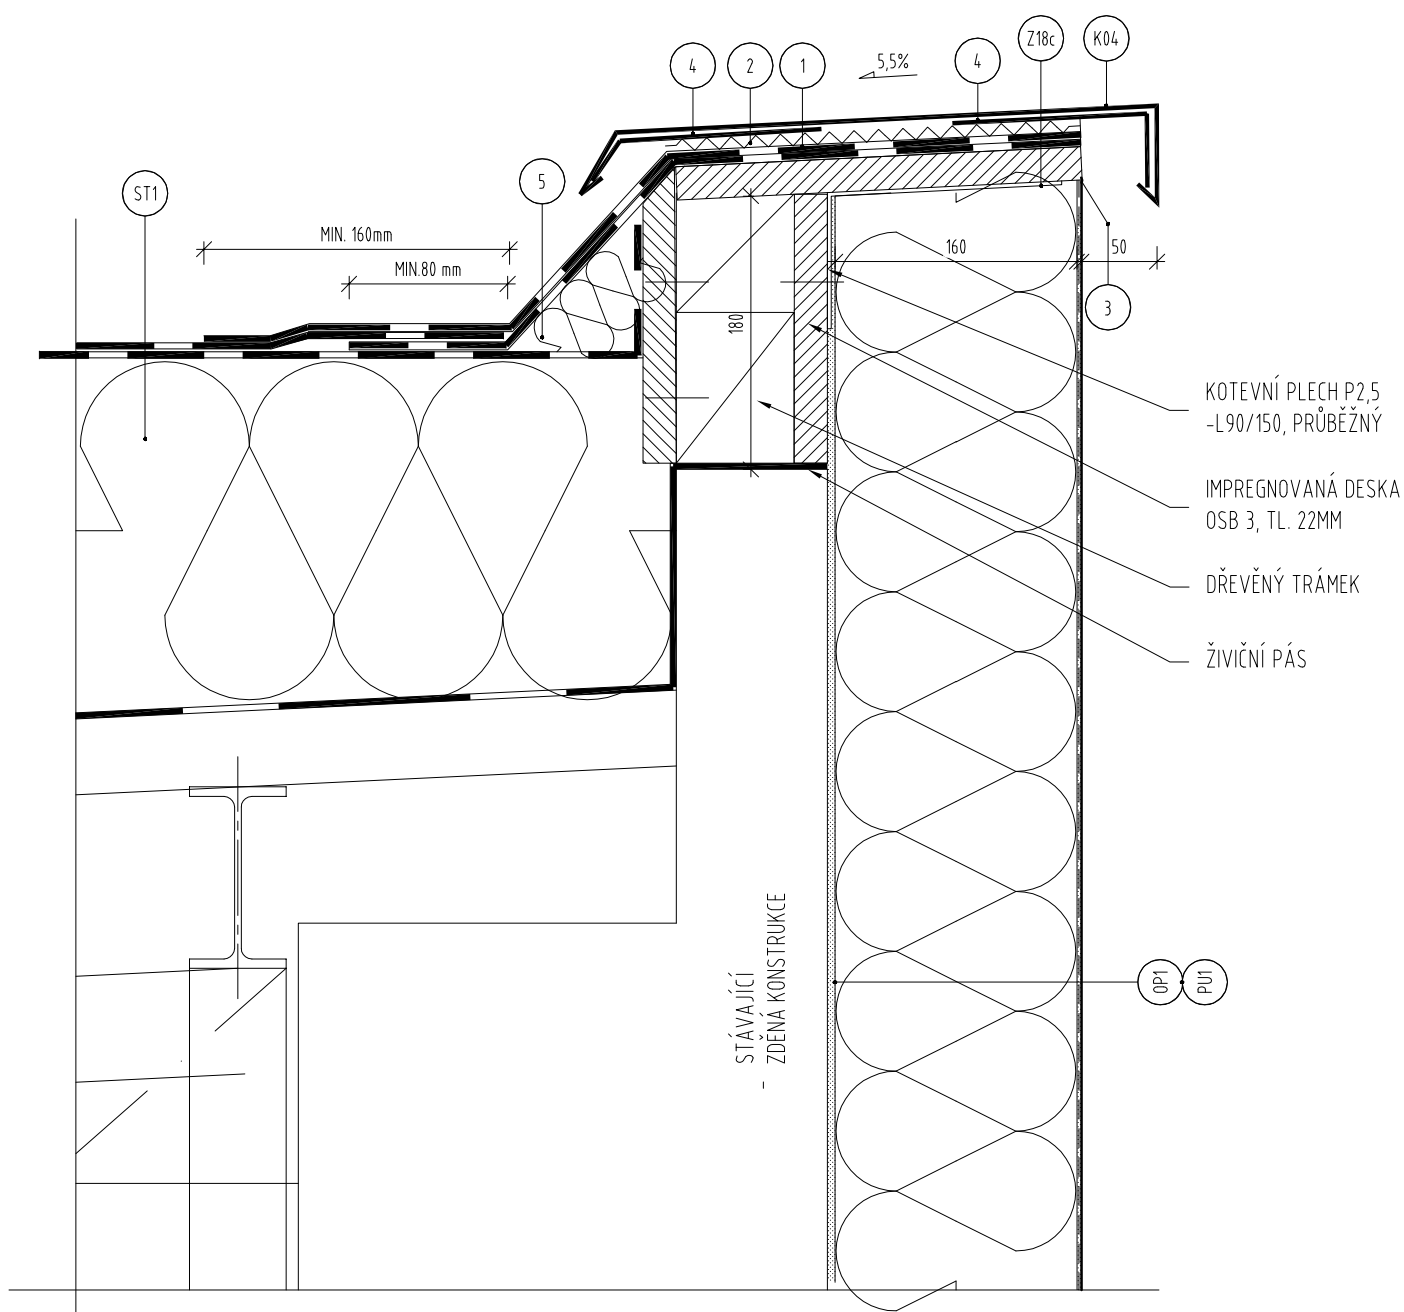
DETAIL - ZUB FASÁDY NAD OKNEM A DETAIL U OKAPU
